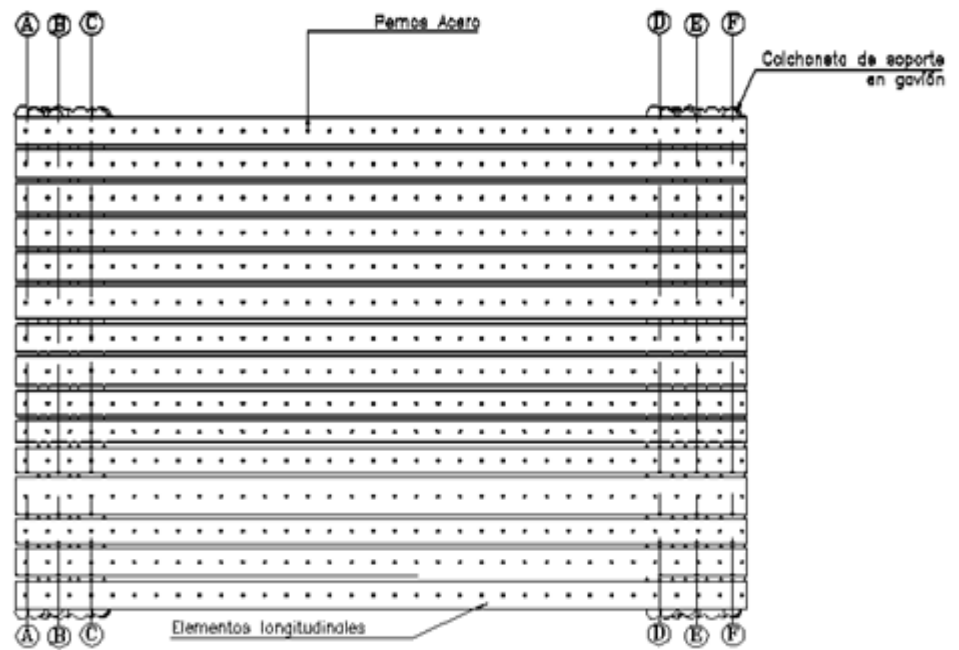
Configuración estructural vista superior (vigas longitudinales)
